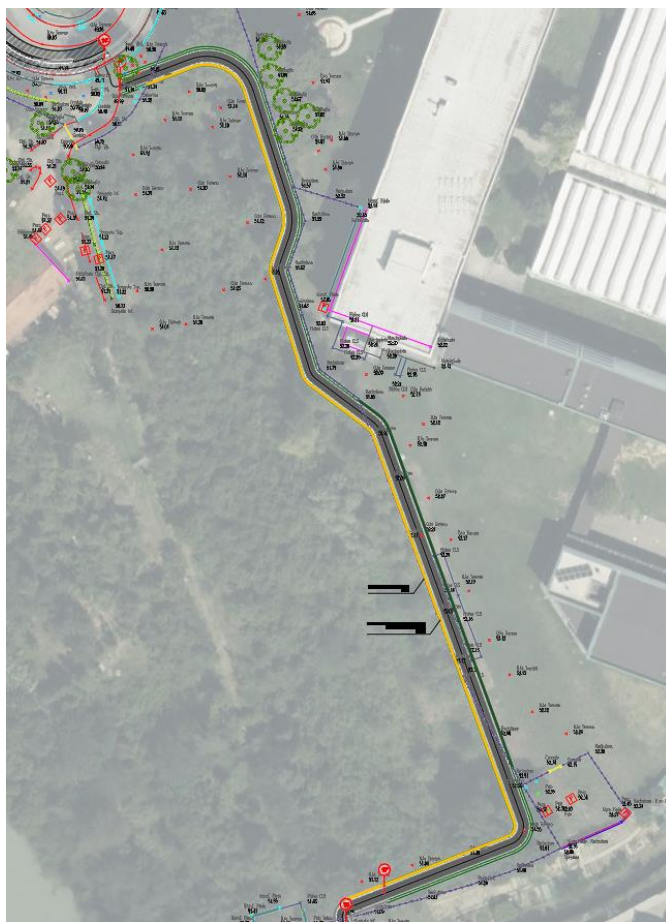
Planimetria ciclovía nell'area degli arcieri del Reno
